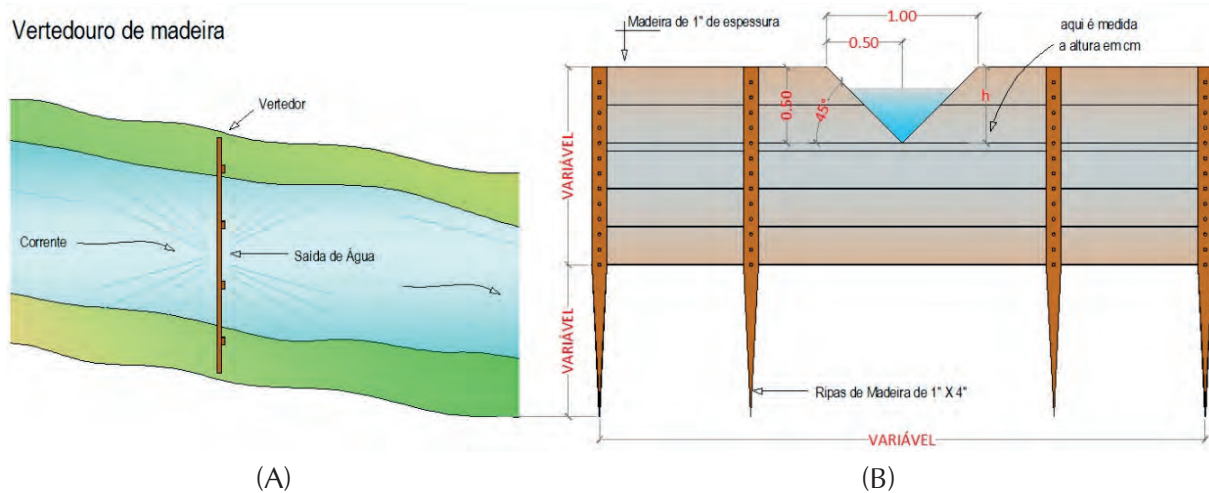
Vertedouro de madeira em planta (A) e na seção transversal (B).
